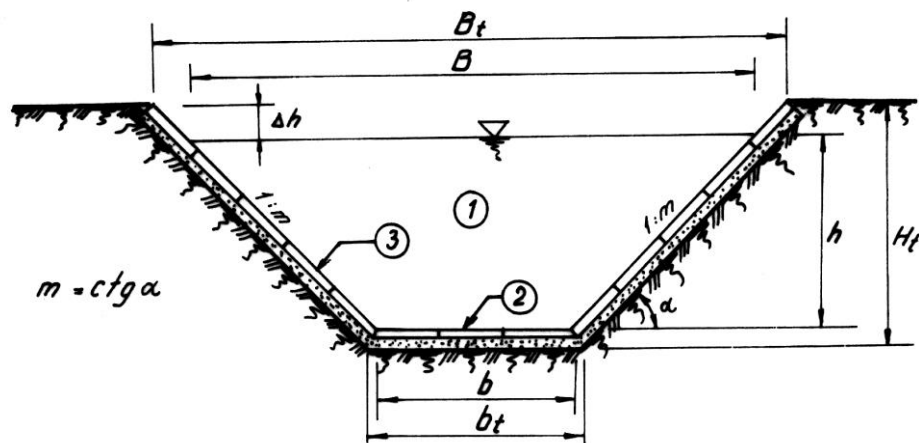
Elementele secțiunii transversale (trapezoidală) ale unui canal
